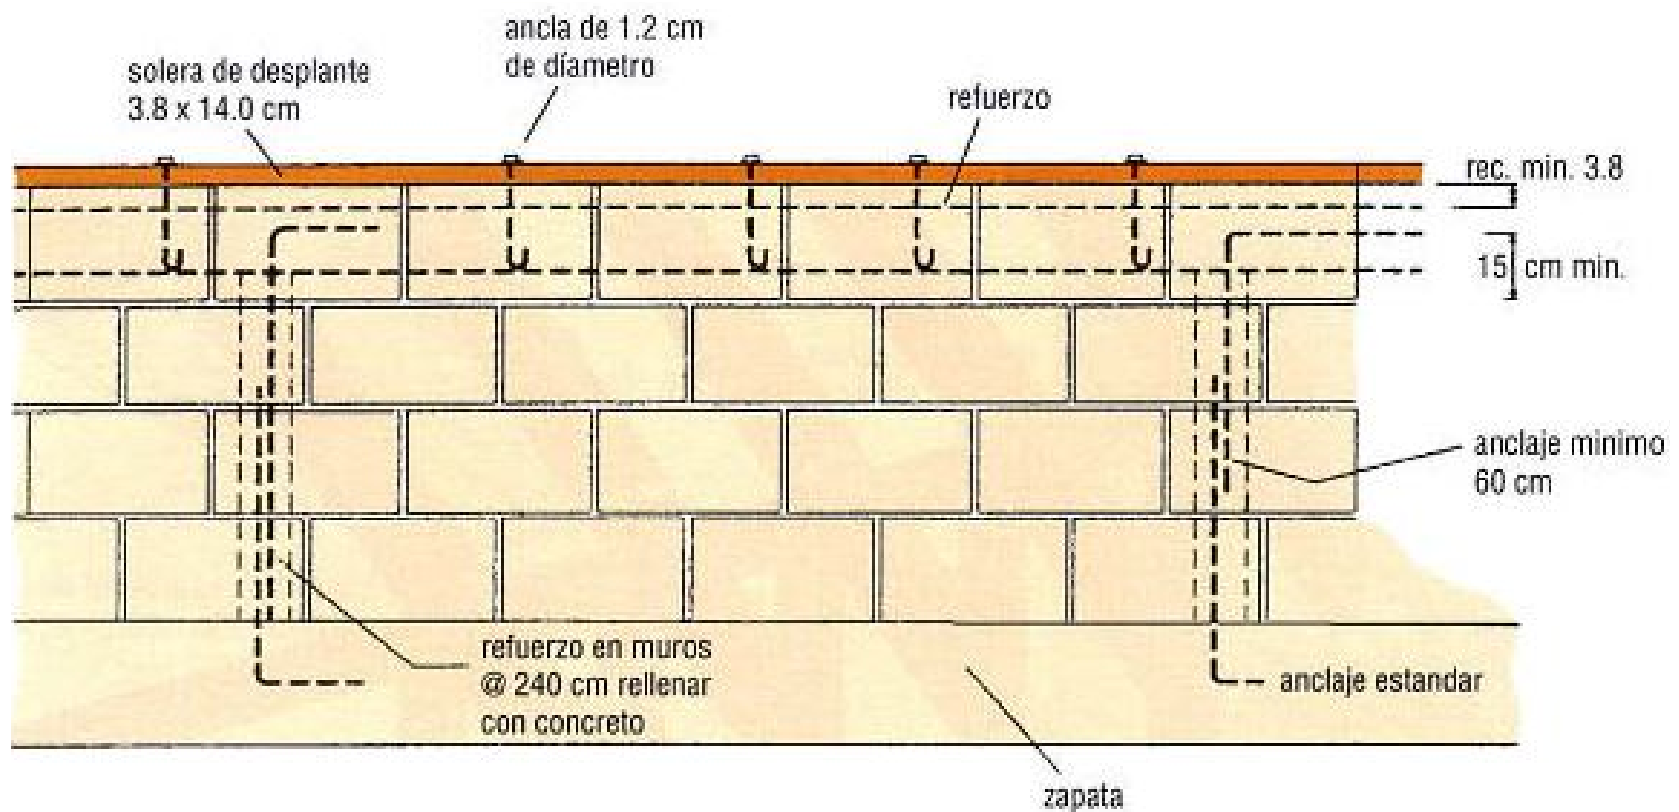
Solera de Desplante Anclada a Cadena de Concreto.
